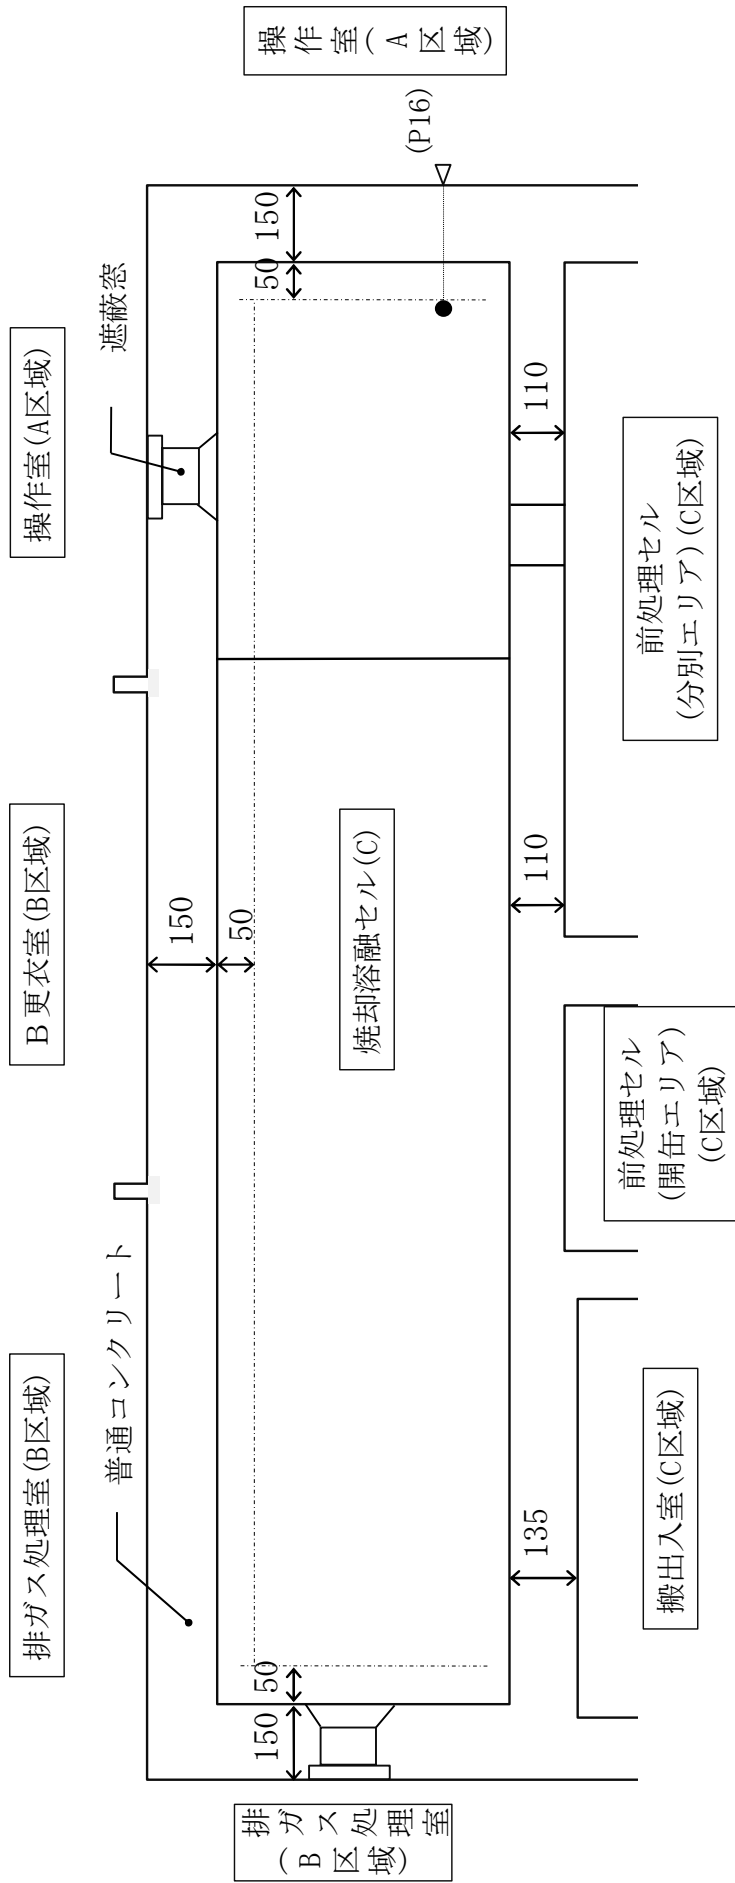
(9) 焼却溶融セルの線量率評価位置図 (地下1階平面図)
